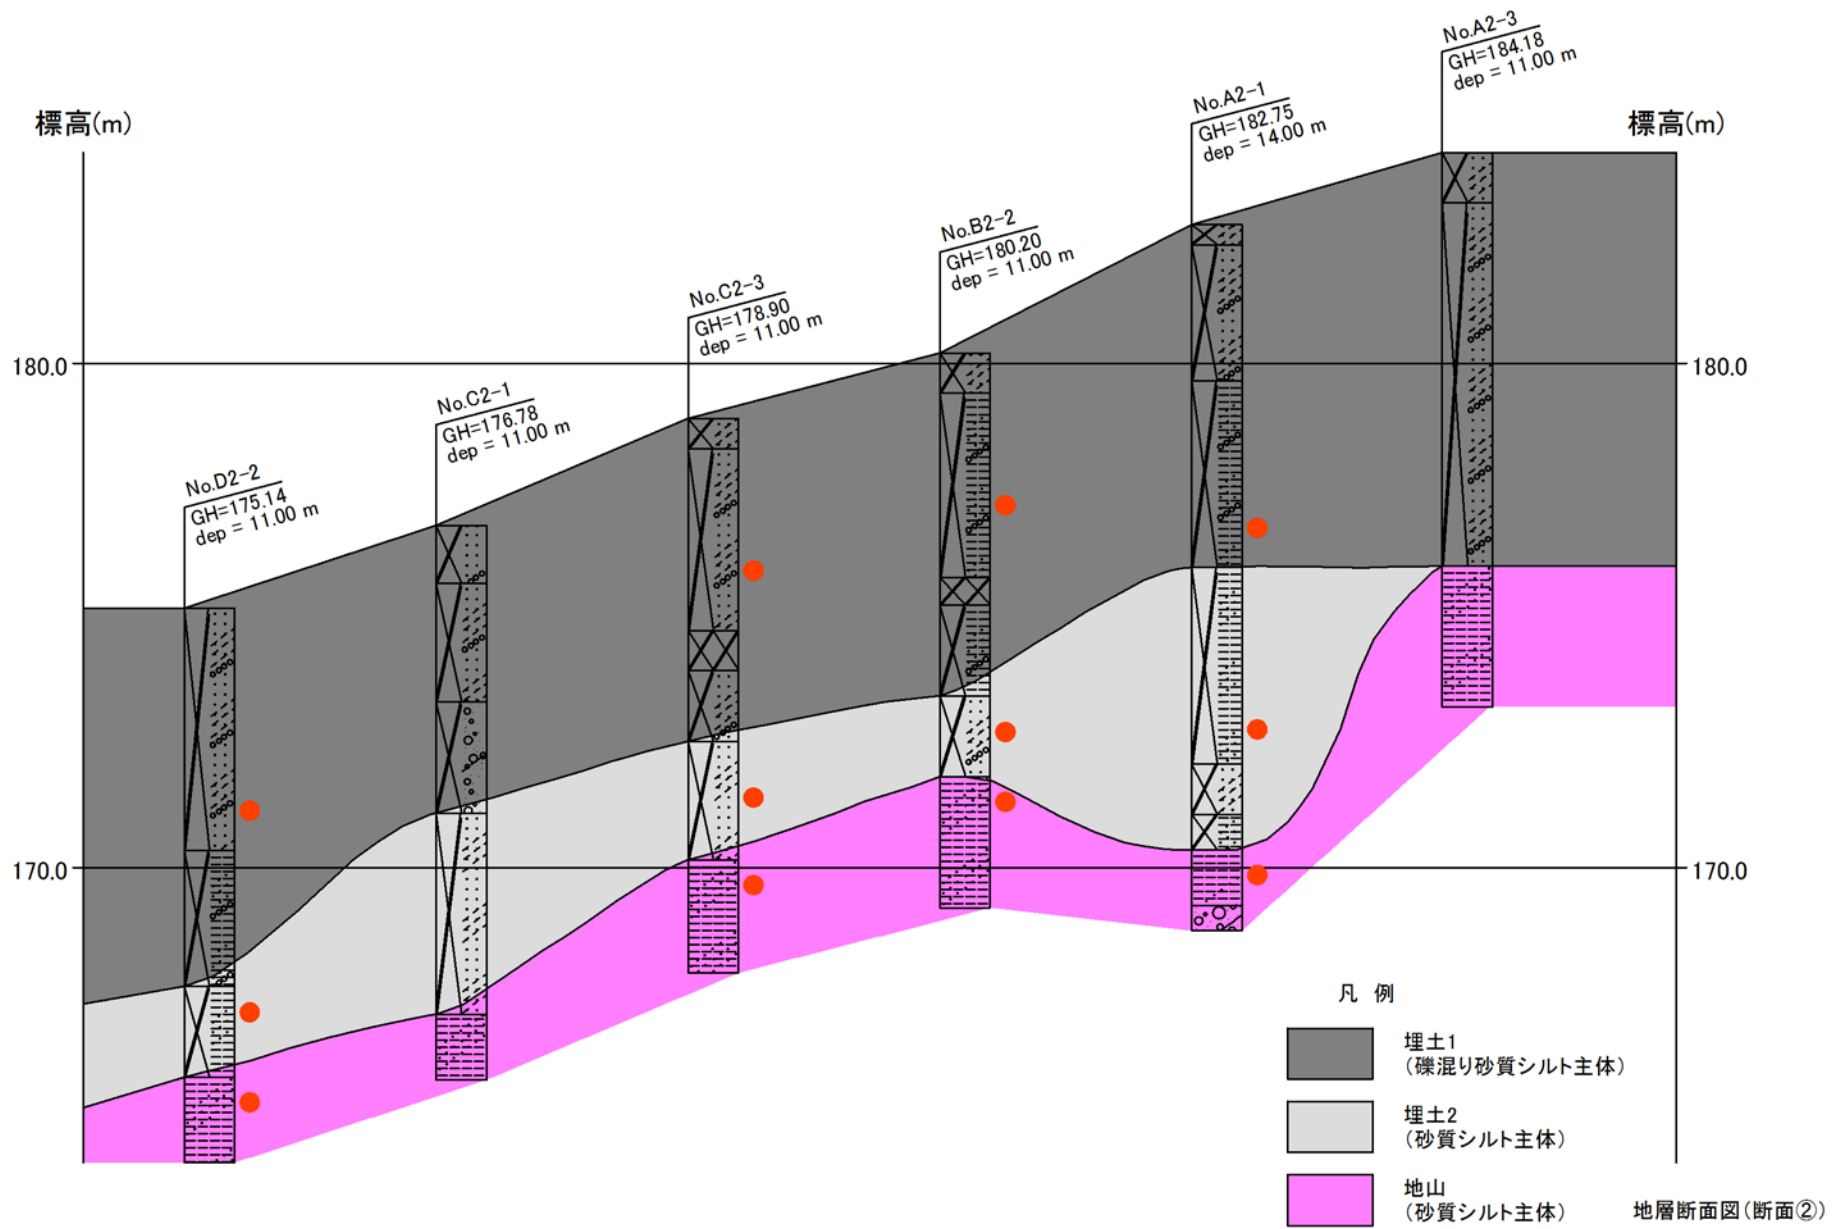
地層断面図 (断面②) (● : コア試料分析深度)
